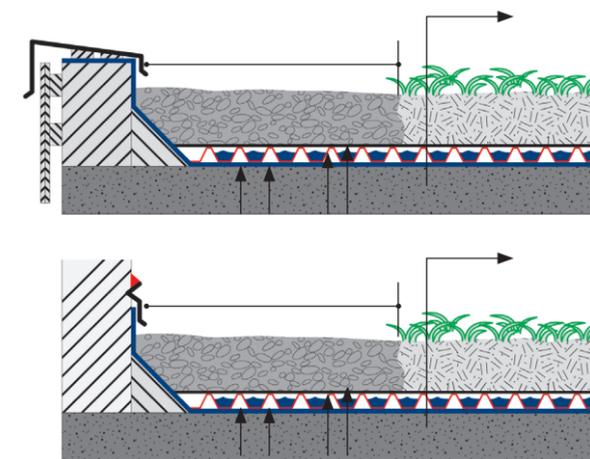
Detalles de encuentro con paramento vertical en cubierta ajardinada
